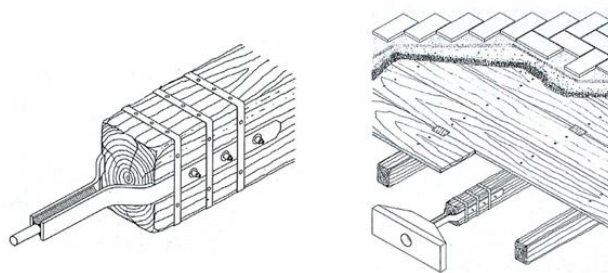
Esquema de uma ancoragem pré-fabricada em betão armado, fixada às vigas de madeira [5]
